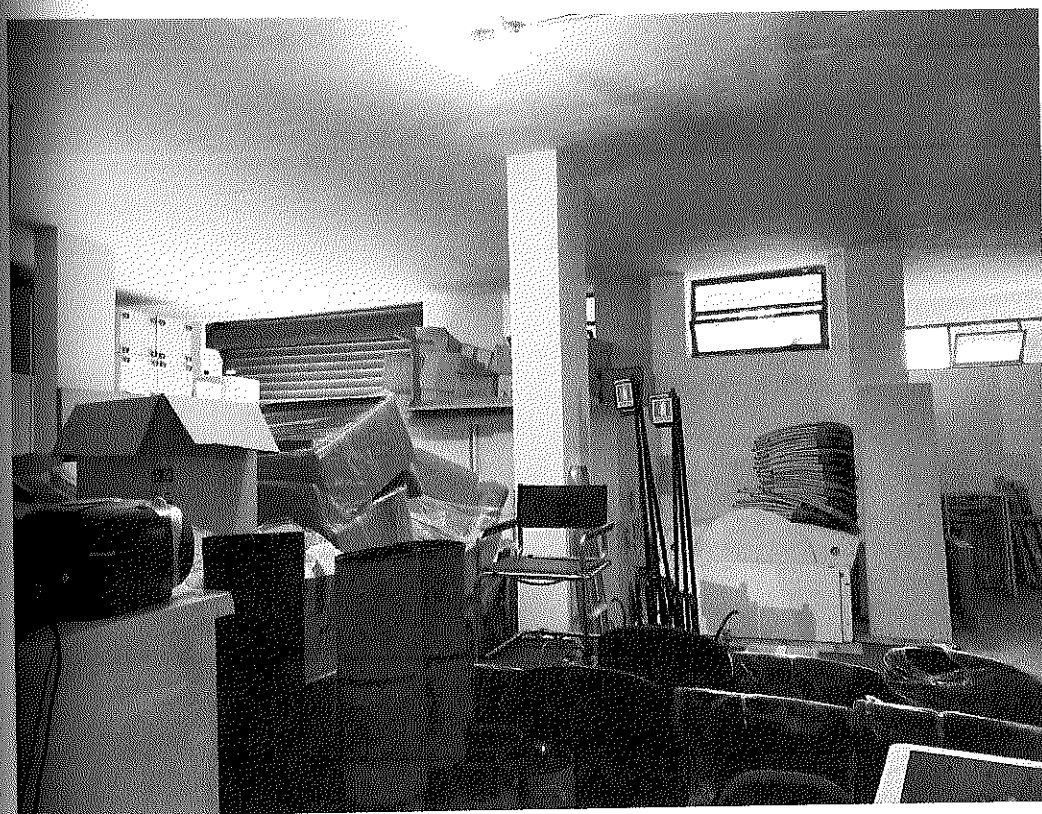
Vista interna dell'autorimessa dove si vede la porta d'accesso.
